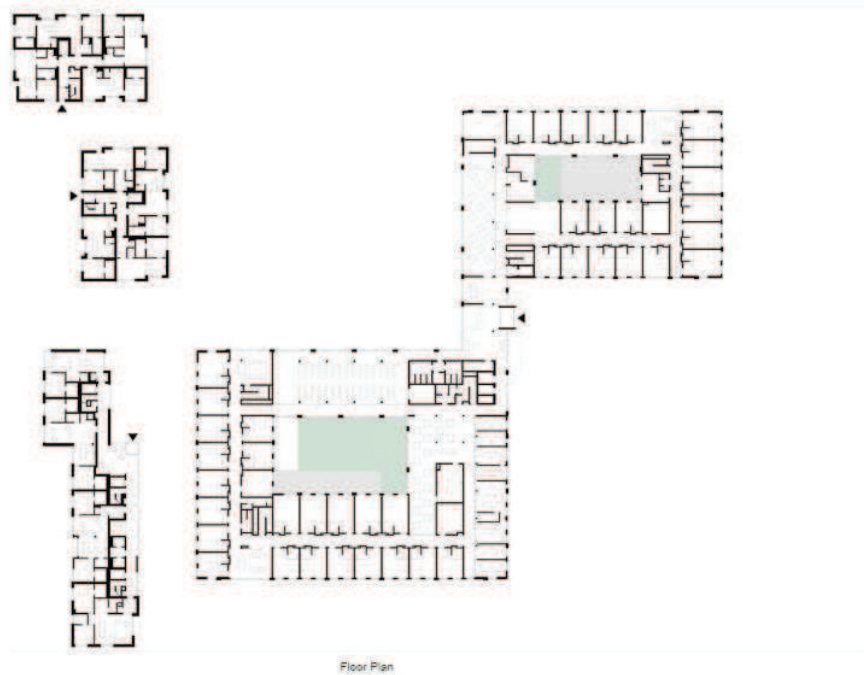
Estudo de caso 2 – planta de conjunto / piso 1
